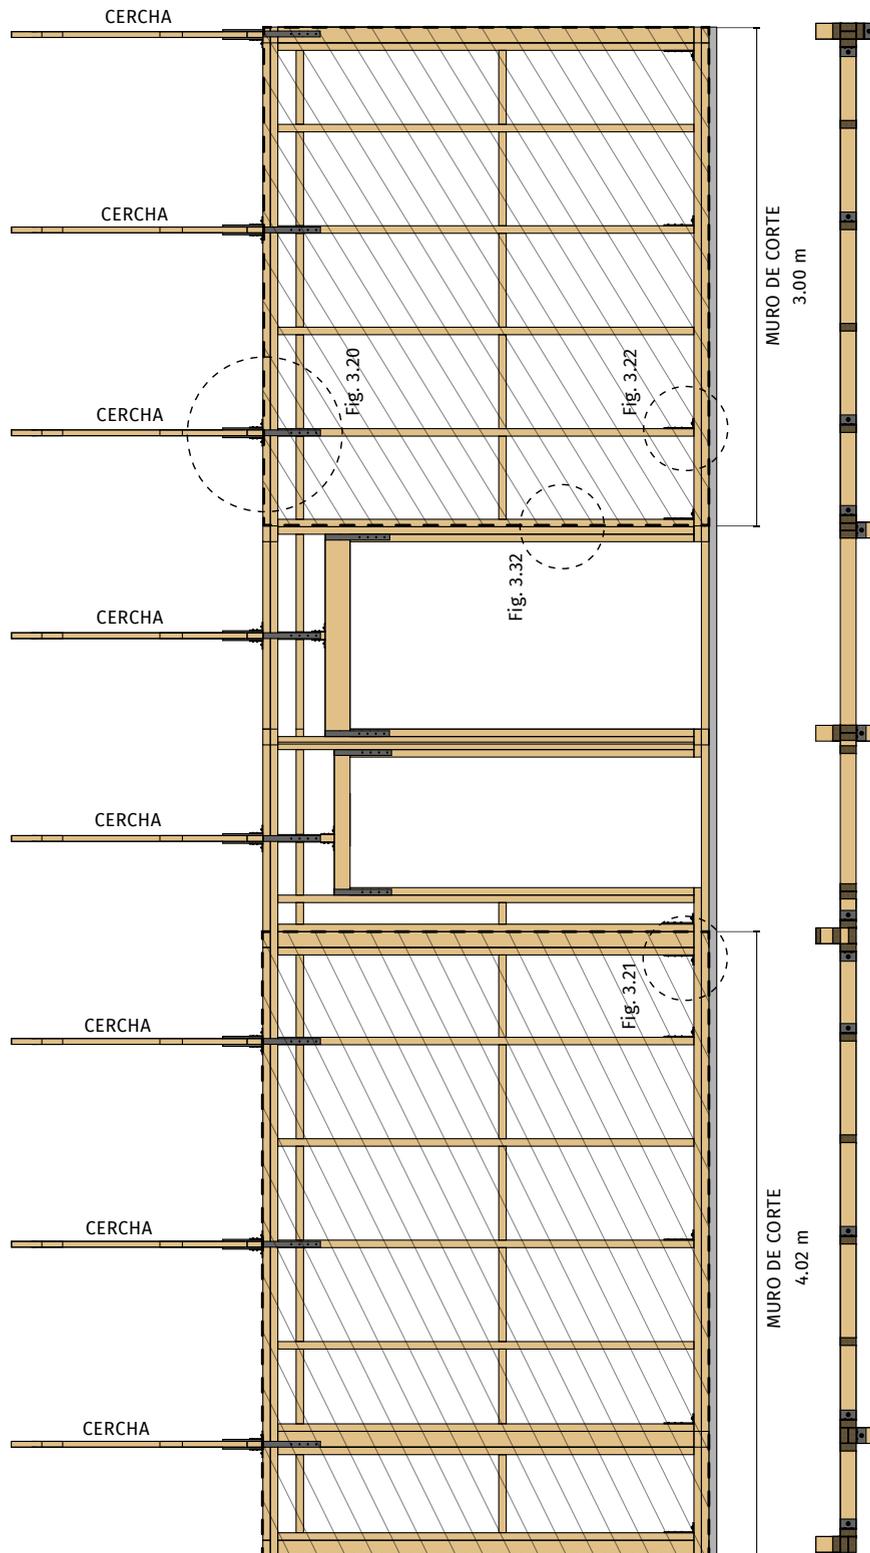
Conformación del muro portante interior donde apoya la cubierta
